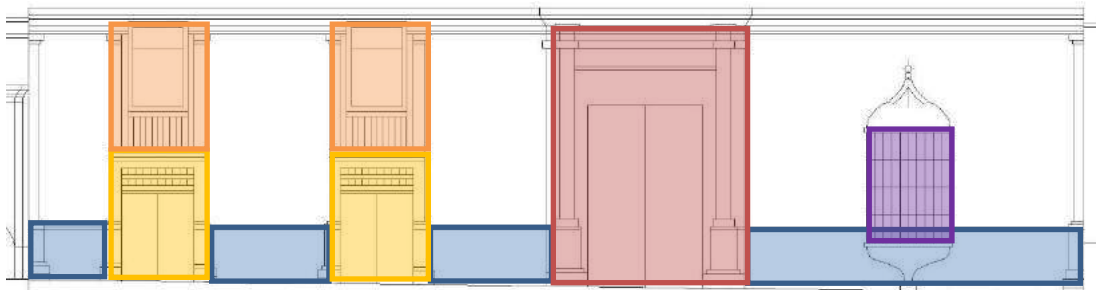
Elevación de la Casa Urquiaga por el Jr. Pizarro
